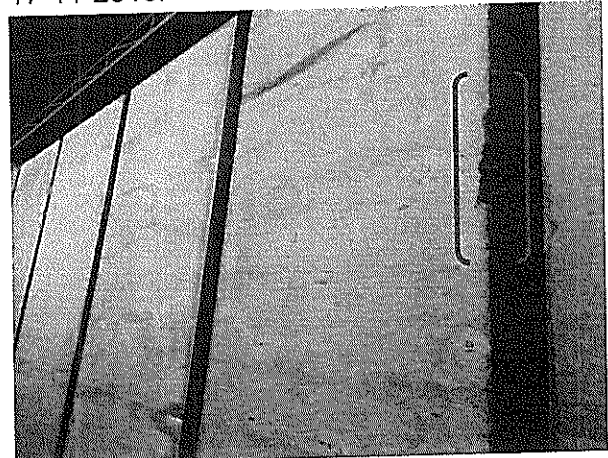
, muros prefabricados de hormigón desaplomados eje Ha del edificio A, 17-11-2015.
